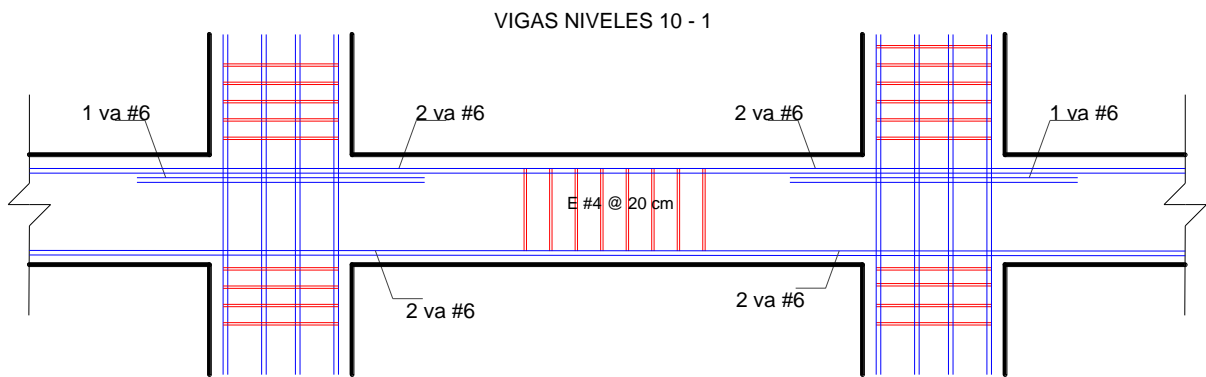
Detallado del refuerzo en vigas para el sistema dual
